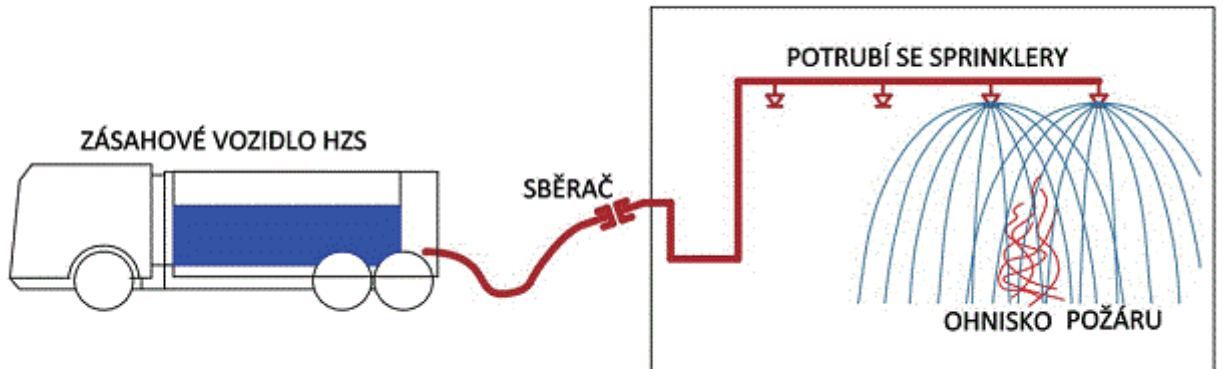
Schéma sprinklerového stabilního hasicího zařízení (9)
